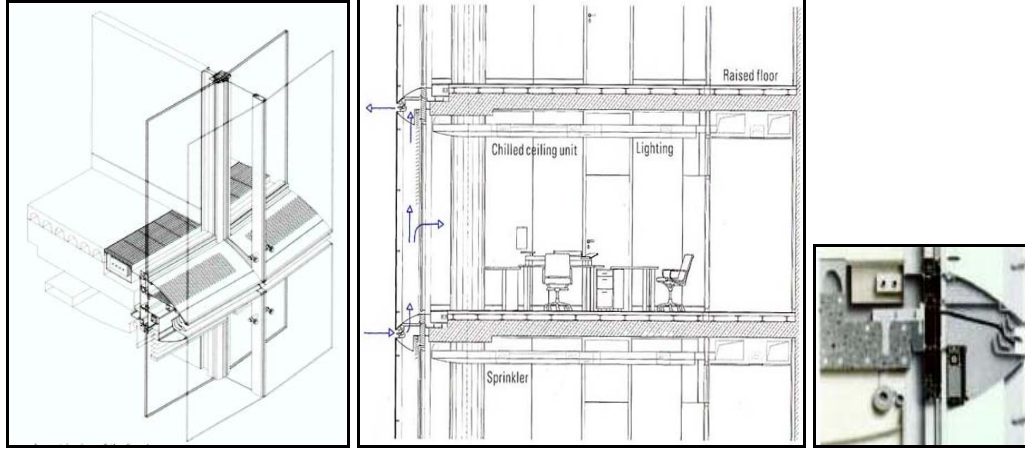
RWE AG Binası plan, kesit ve görünüşü [34-35]
